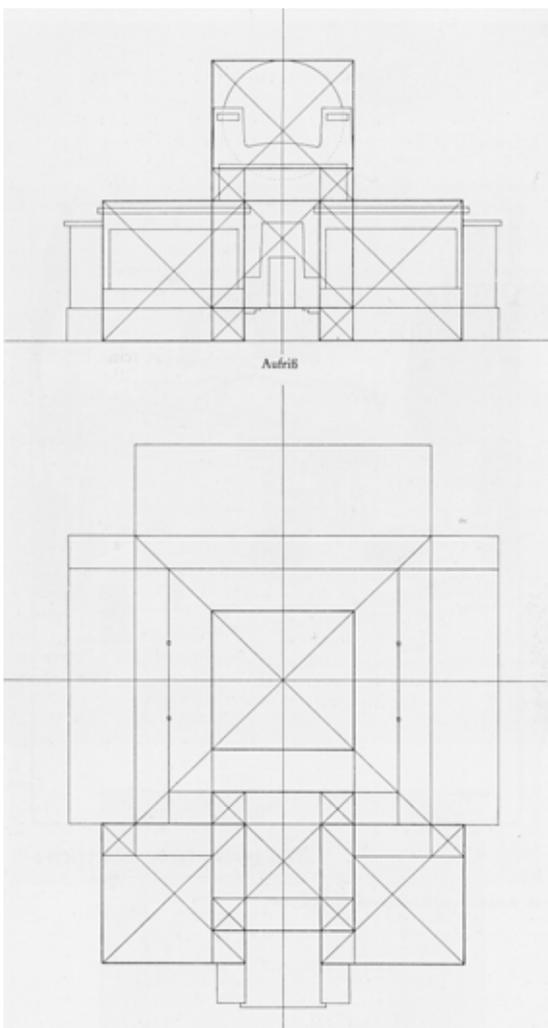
Geometría intrínseca de la planta y el alzado del edificio de la Wiener Seccion. Toda la composición se basa en el cuadrado y el círculo
